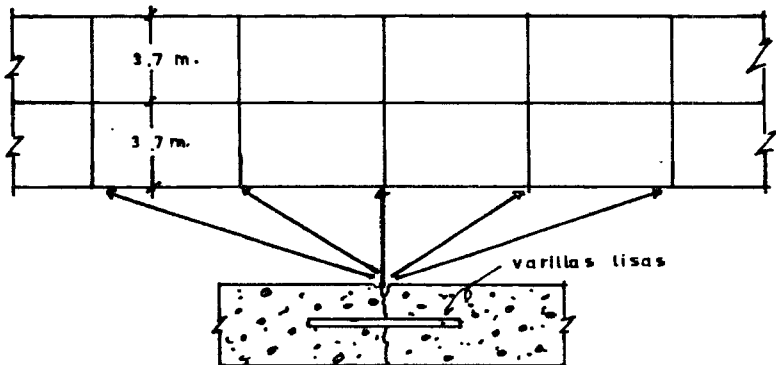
Pavimento de concreto simple con refuerzo en las juntas
